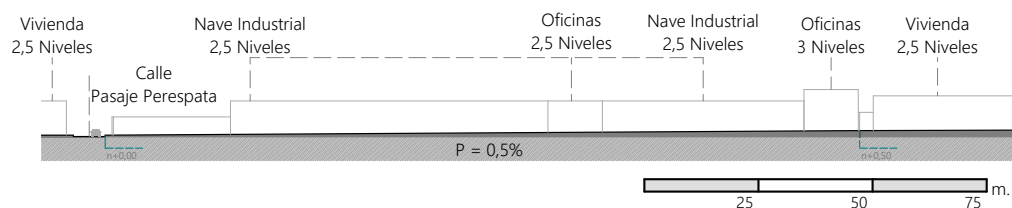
Sección longitudinal B-B con dirección al sitio, se identifica altura de los elementos construidos existentes y pendiente del predio. Elaboración: Autor.
